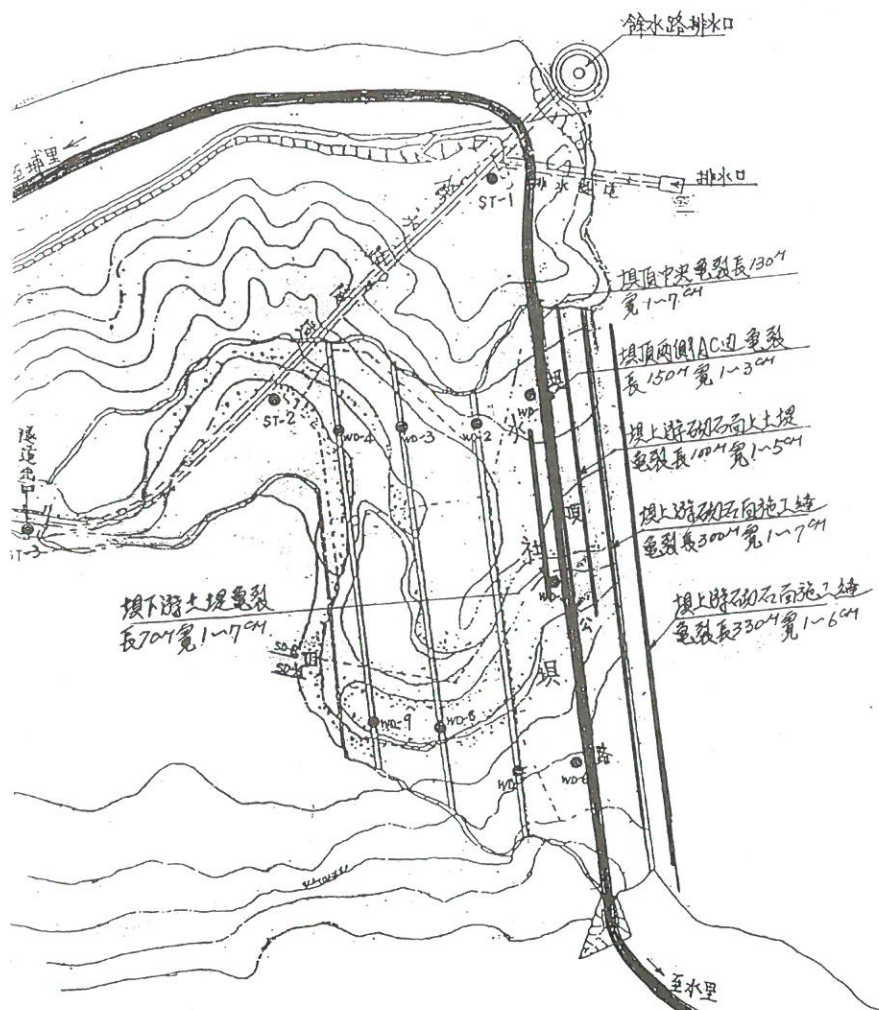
水社ダム平面図上の亀裂の位置、長さおよび幅
